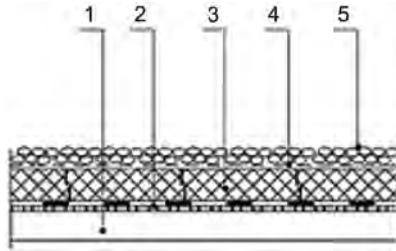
Устройство плоской инверсионной кровли: 1 — перекрытие; 2 — гидроизоляционный ковер;
